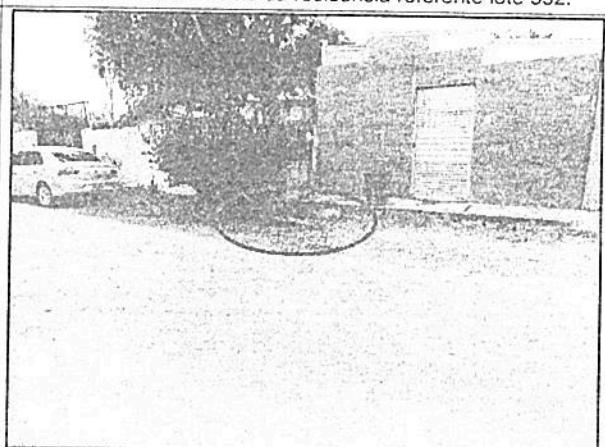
Caixa de pass. de efluentes sanit. na dren. pluvial.
